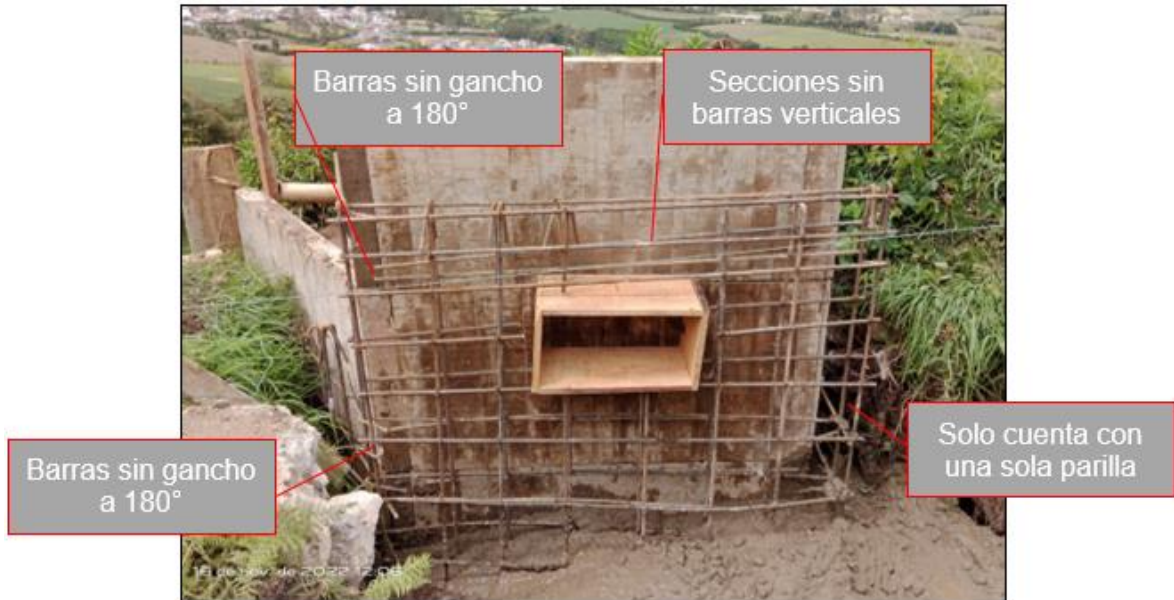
rechazo en la armadura de una alcantarilla
